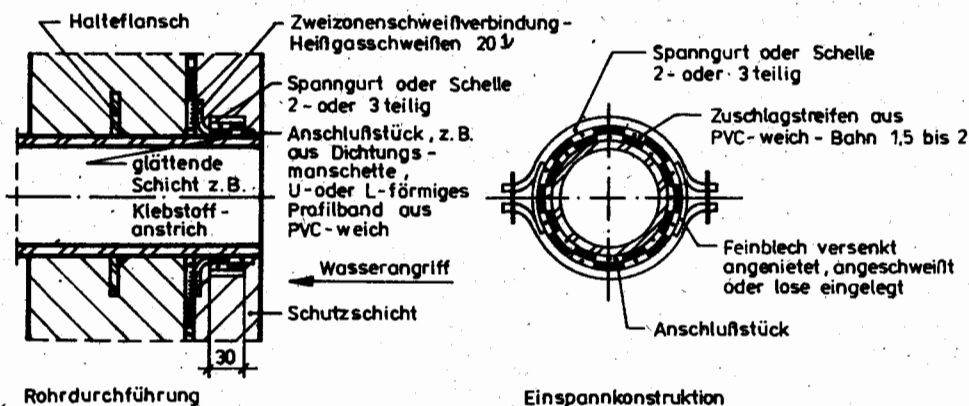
Anschluß bei nicht mit PVC-weich verschweißbaren Rohren
